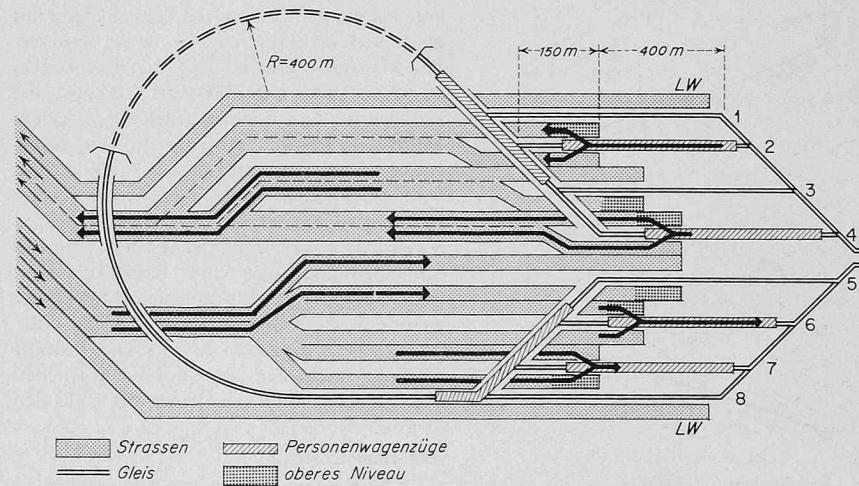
Stationsschema 4 mit Wendeschleife. Je ein Ladegleis für Lastwagen, drei Gleise für Personenautos; einstöckige, in der Höhe versetzte Rampen. Gesamtbreite der Station rund 90 m
